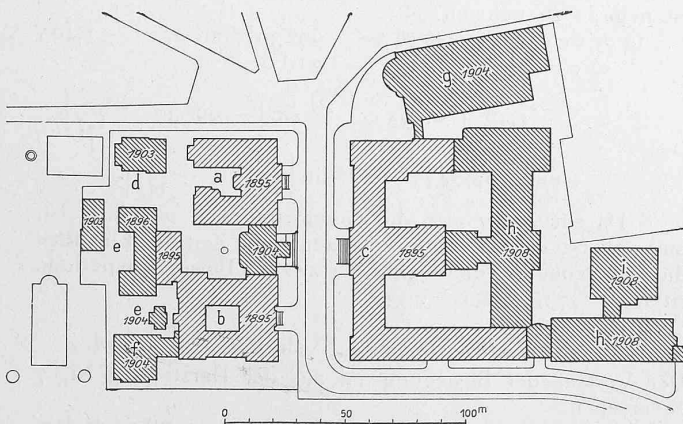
Gesamt-Lageplan der Techn. Hochschule Darmstadt. — 1 : 3000.
